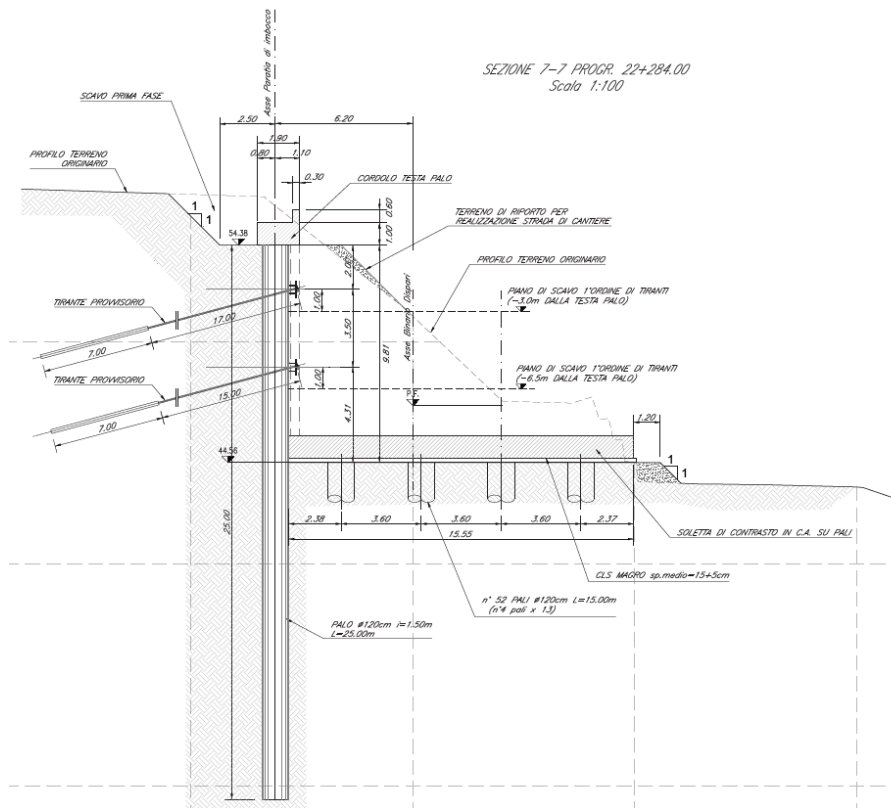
Sezione trasversale di scavo sezione tipo G, configurazione a singola paratia
